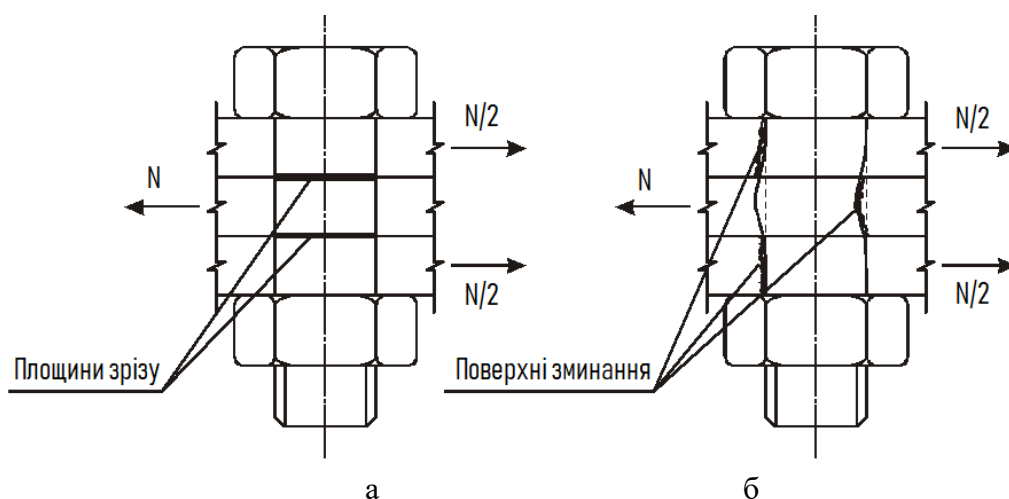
Робота болтового з'єднання: а – зріз стержня болта чи заклепки; б – зминання металу
